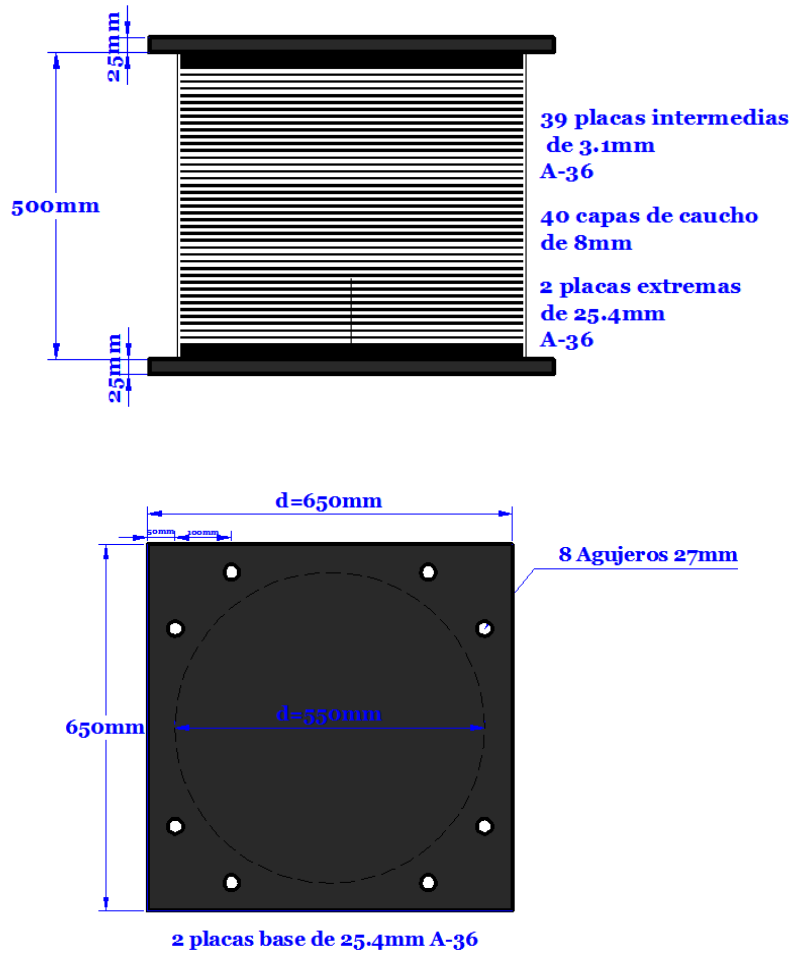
Dimensiones del aislador de caucho de alto amortiguamiento diseñado
